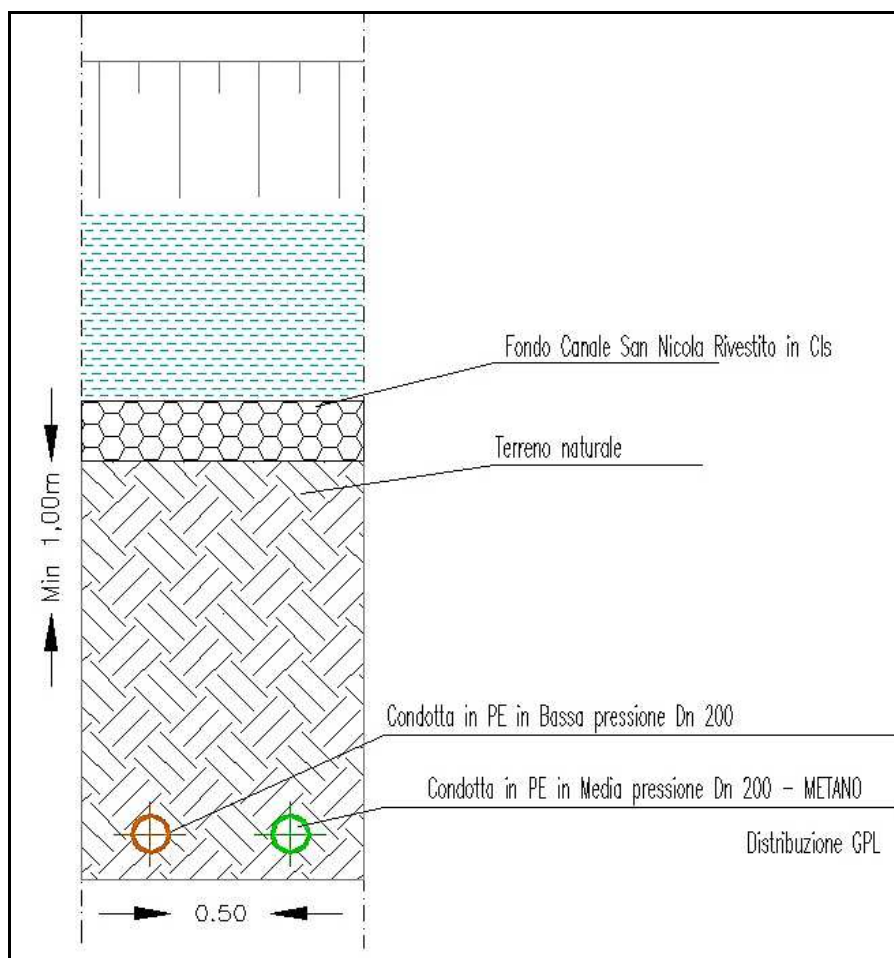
Sezione di progetto in corrispondenza del letto del canale.
